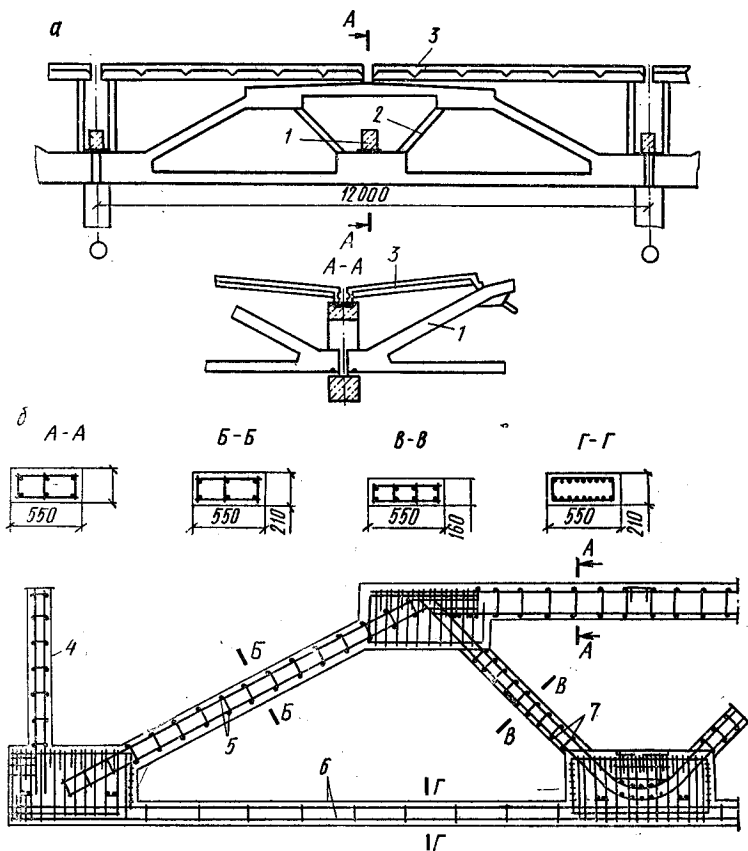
Конструкция (а) и армирование (б) подстропильной фермы
